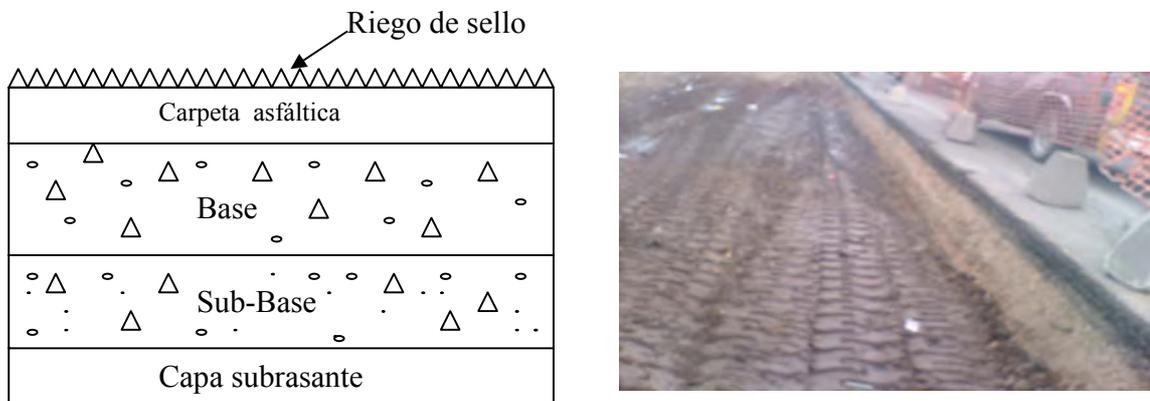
Capas que forman en general un pavimento flexible
